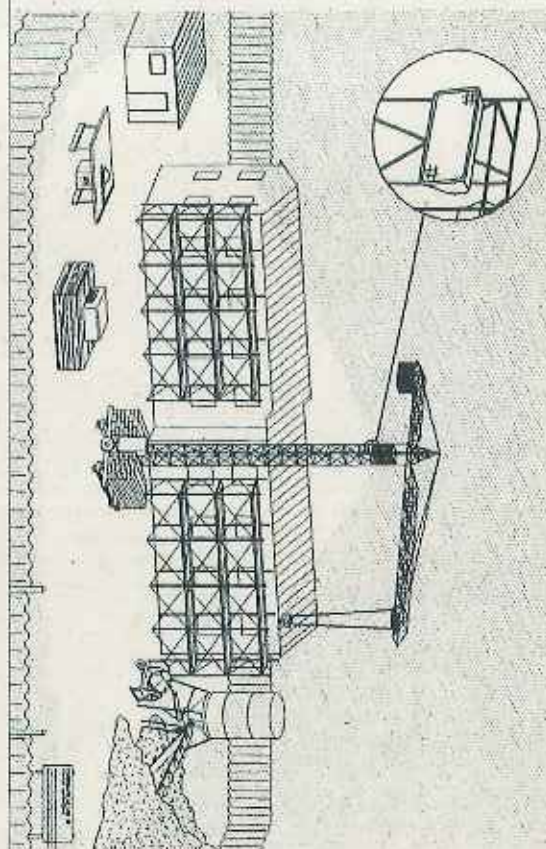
Apparecchi d'illuminazione del cantiere installati sulla gru.
